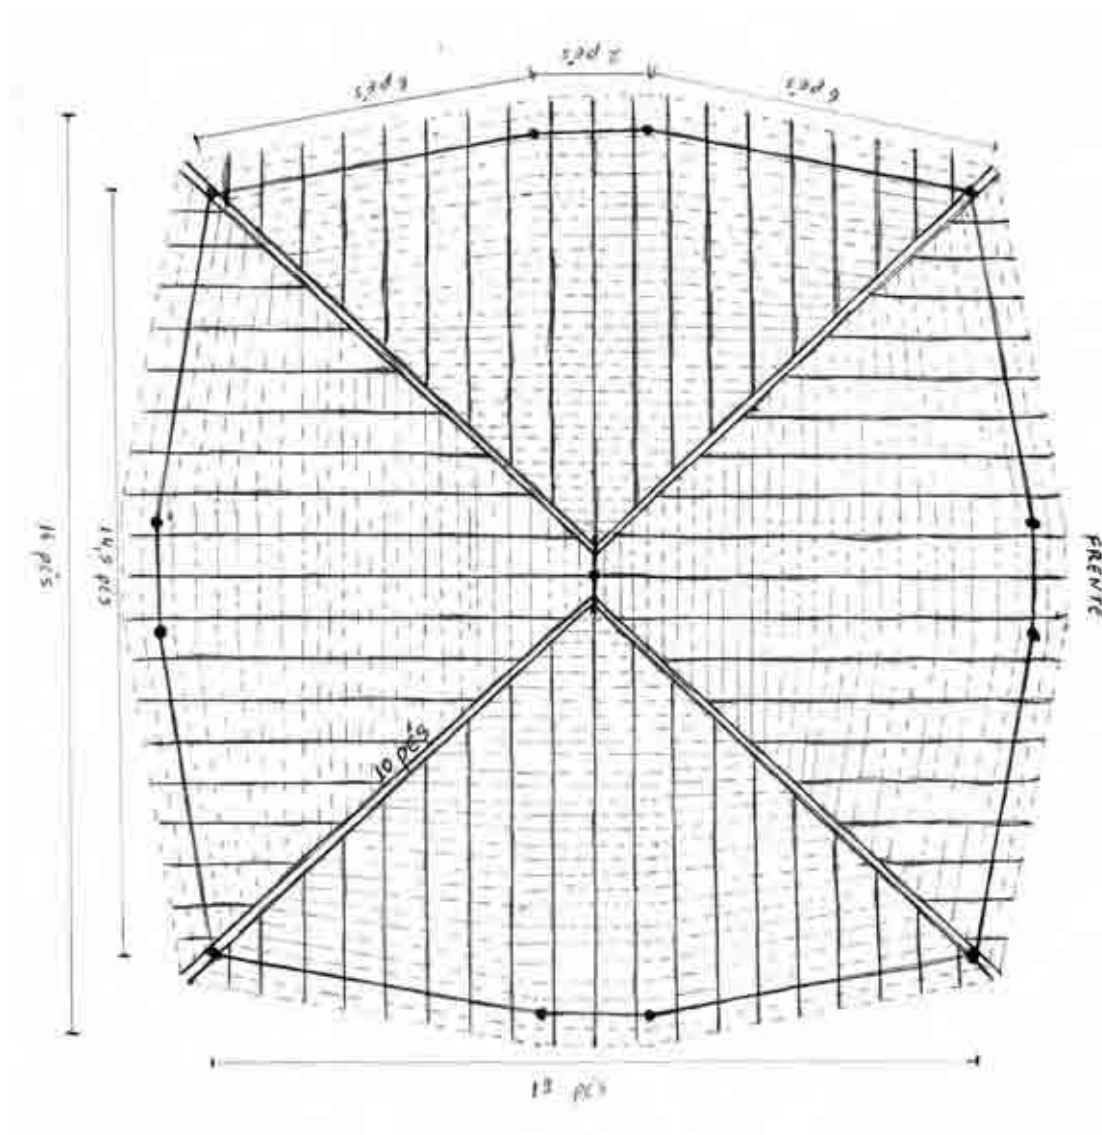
Vista superior e planta baixa de uma construção observada em 11/04/05 pelo autor.
